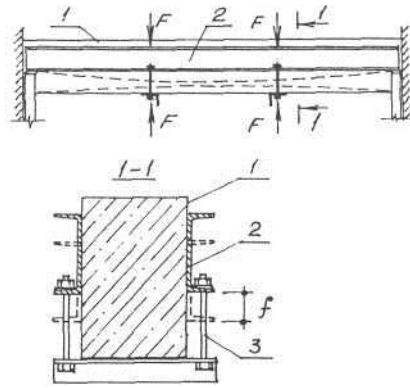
(1 — железобетонная балка, 2 — стальная балка, 3 — натяжные болты)
